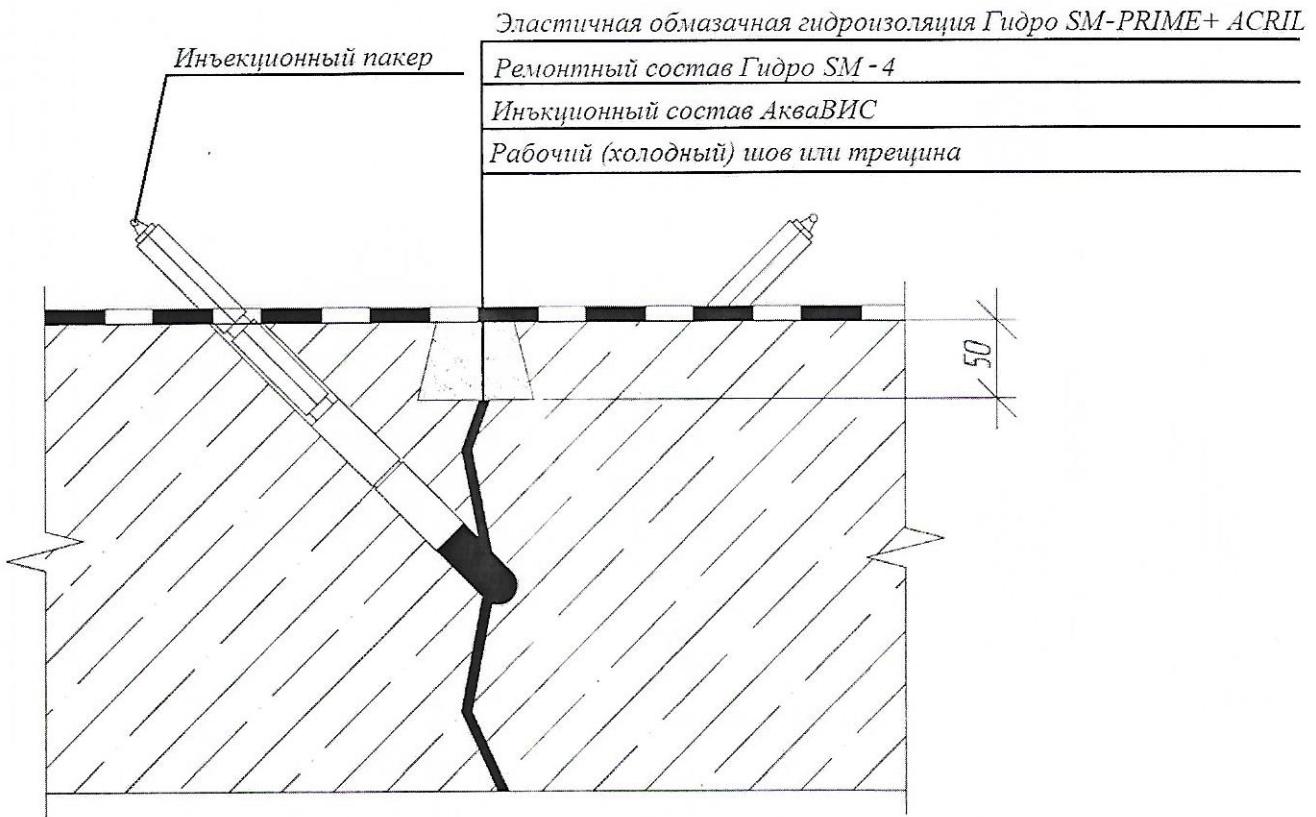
Схема гидроизоляции рабочих швов и трещин
